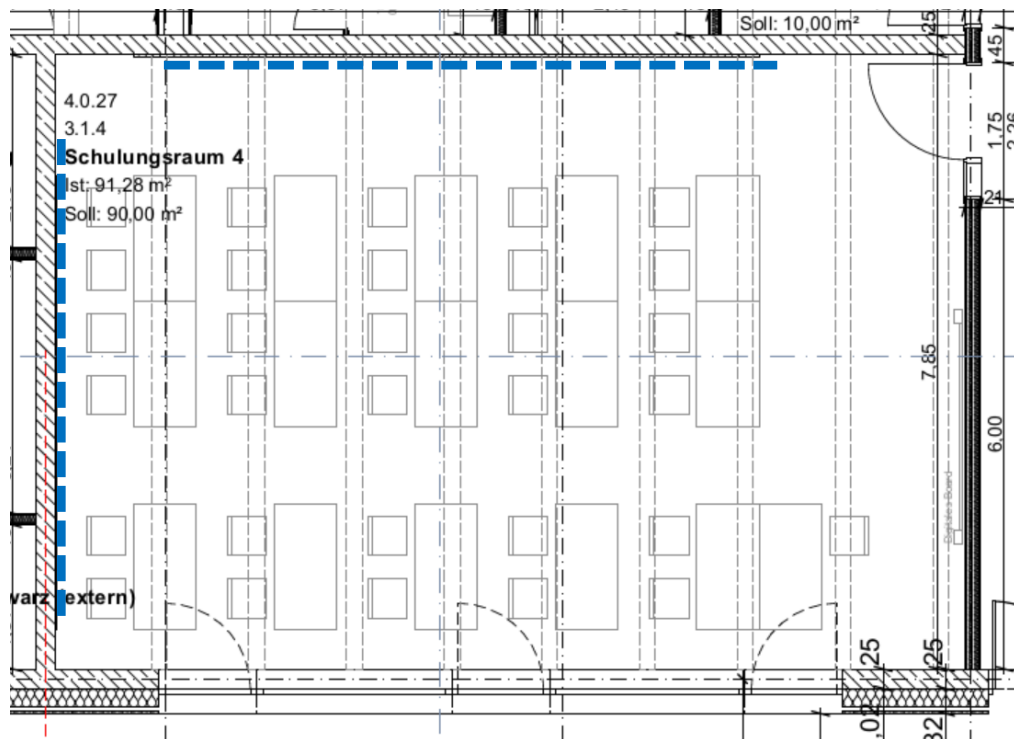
Grundriss Schulungsraum 4 mit Bestuhlung und Wandabsorbieren (blau gestrichelt)
